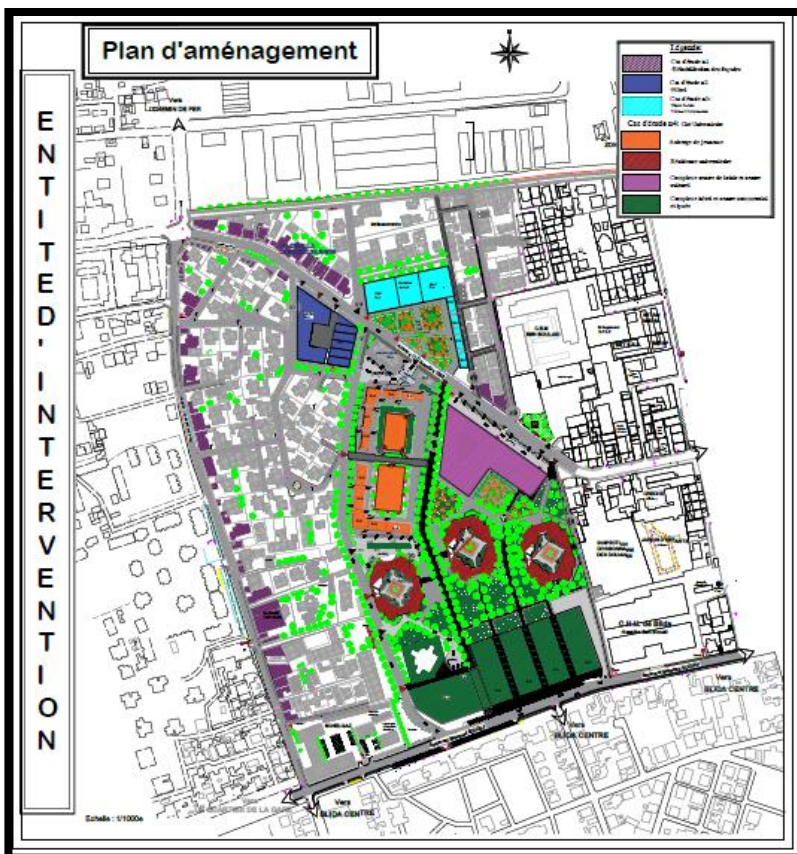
32 : Plan d'aménagement /Support de travail POS Ben Boulaid/ traité par l'auteur.
